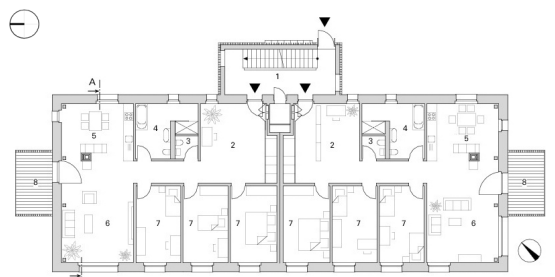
Pianta piano tipo; Fonte: www.720grad-architekten.ch
